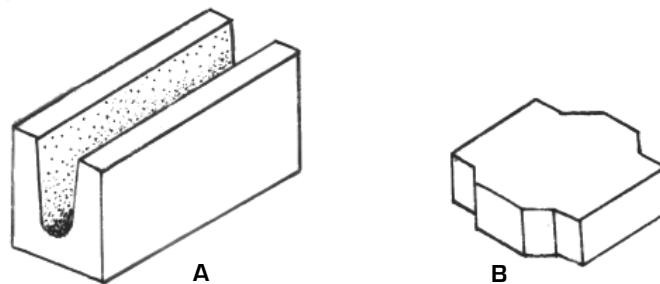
Formas de bloques de hormigón: a) bloque u y b) bloque pavimento.
